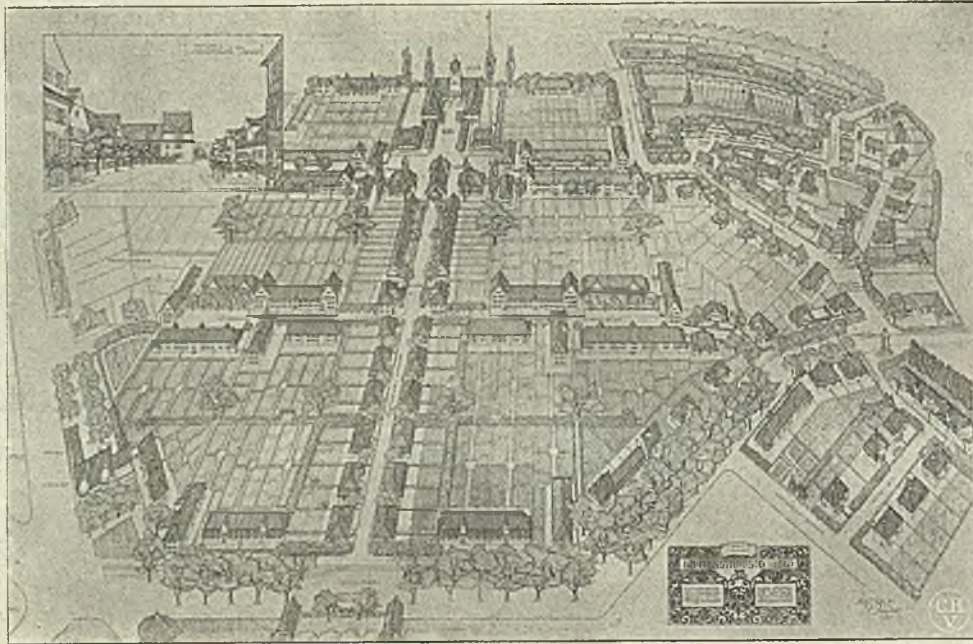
Gartenstadt Stockfeld bei Straßburg i. E.
